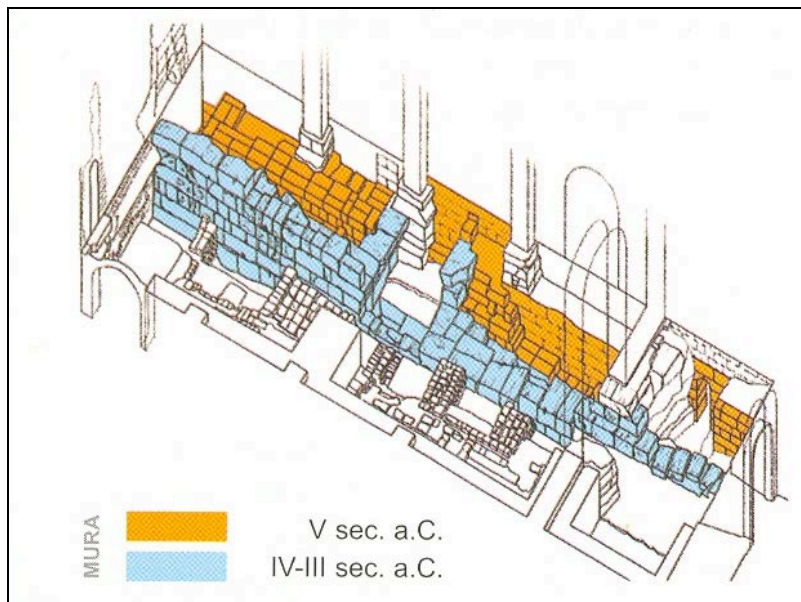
Planimetría de las dos murallas documentadas bajo el Palazzo dei Normanni en Palermo correspondientes a su fase I, en naranja, y II, en azul. En ella se puede observar la muralla del tipo M.0 de la fase II que utiliza la cara externa de la muralla de la fase I como paramento interno (Spatafora, 2005c).
